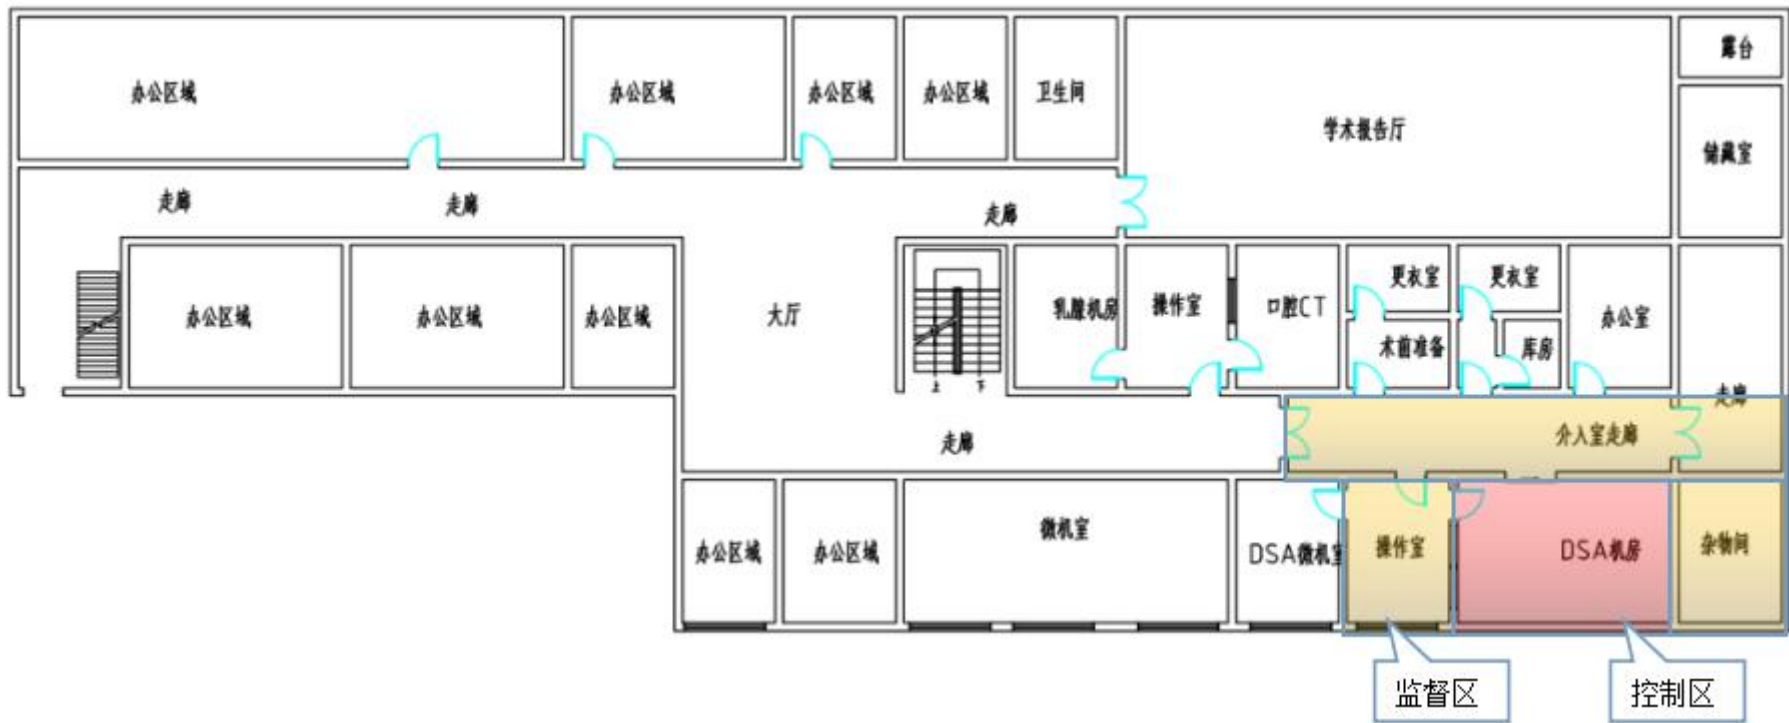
本项目 DSA 机房所在 1 号楼（二层）平面布置示意图
